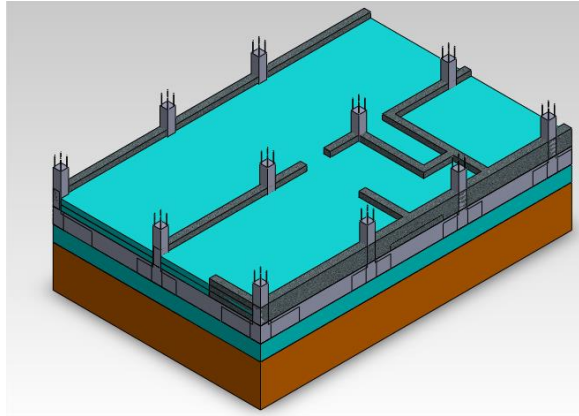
Colocación de suelo estabilizado con RCDTP en fondo de falso piso.
